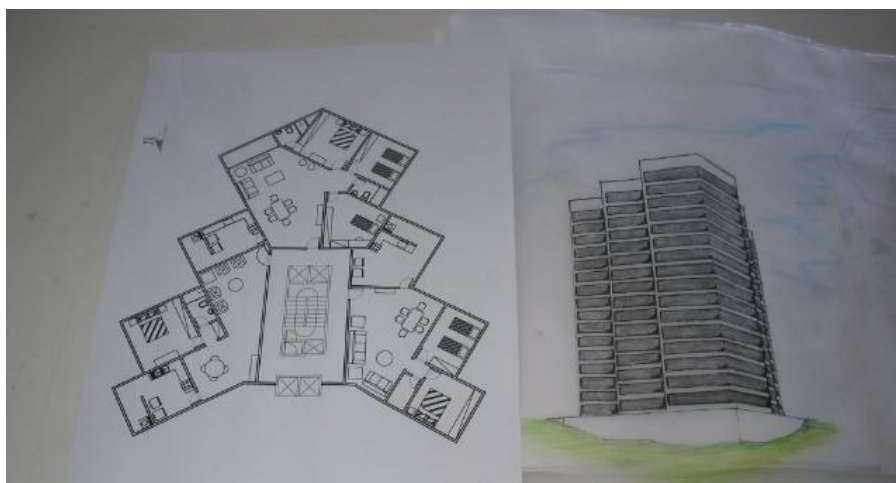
Proposta para edifício. Planta Baixa e Perspectiva da Fachada. Ateliê III - Turma A.
